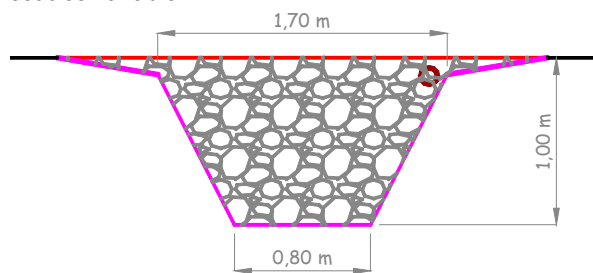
Section transversale de la tranchée d'infiltration étudiée
